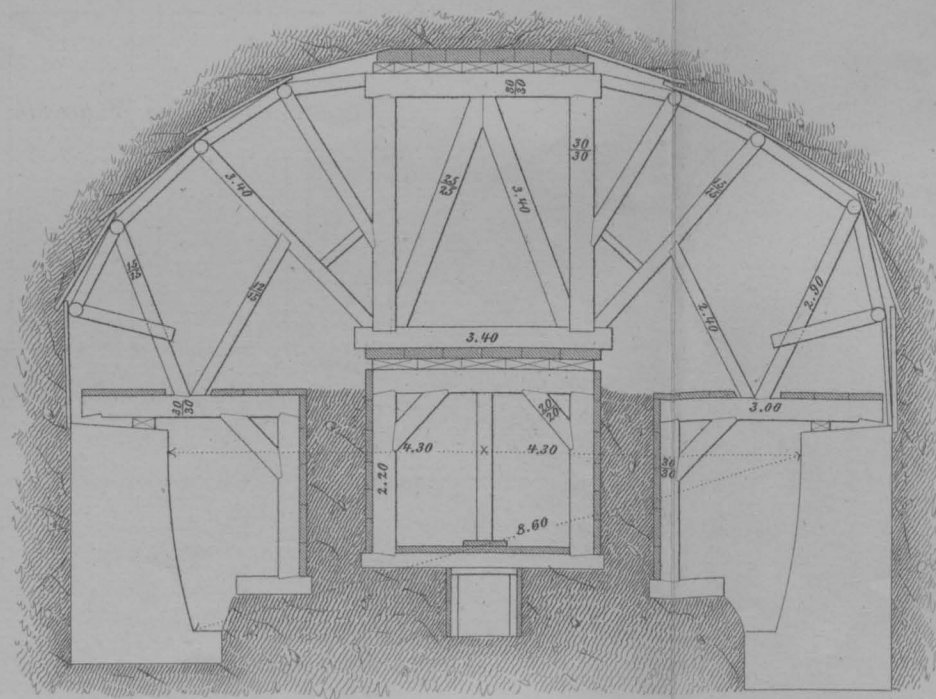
Querschnitt der: Zimmerungen. Leer-Gerüste.
